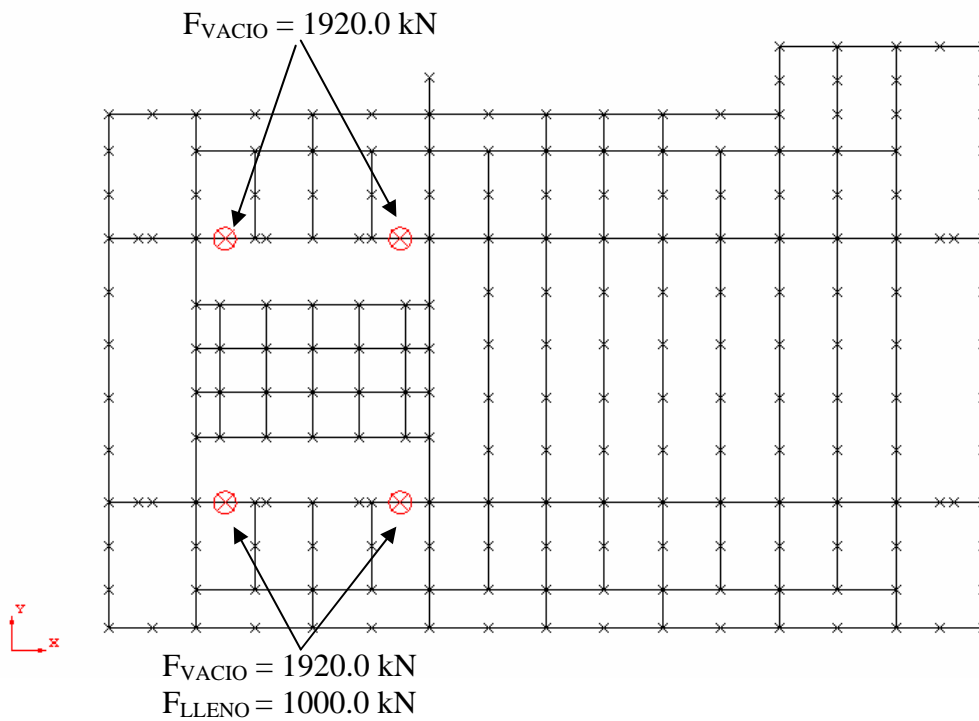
Torre de perforación – Tuberías – Aplicación de cargas.
